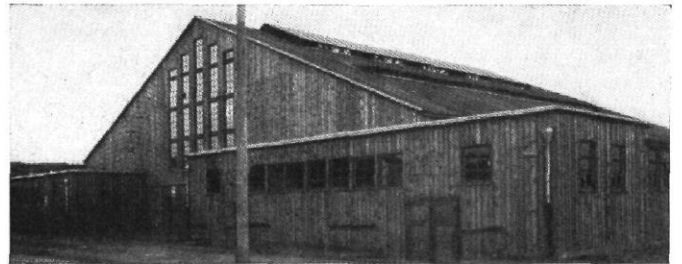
/ Ausstellungshalle Köln / Architekt: Pieper-Köln
